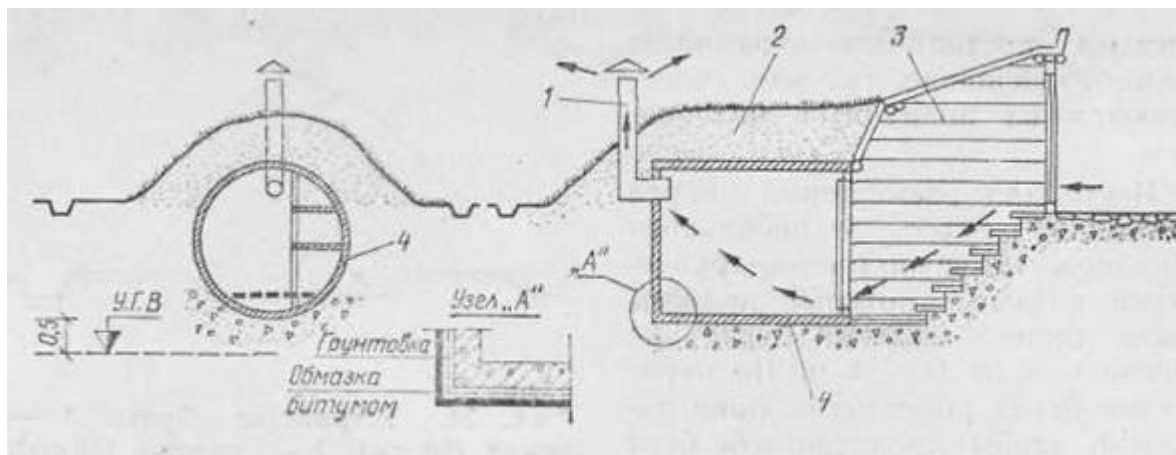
Погреб из железобетонных колец: 1 – вытяжка; 2 – обваловка грунтом; 3 – входной тамбур; 4 – бетонные кольца
